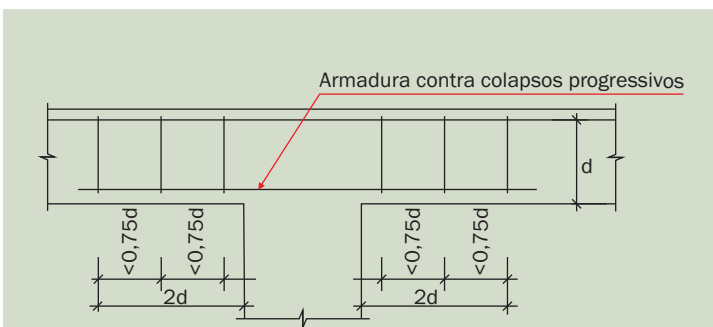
ESTRIBOS COMO ARMADURA DE PUNÇÃO - VISTA EM CORTE TRANSVERSAL
